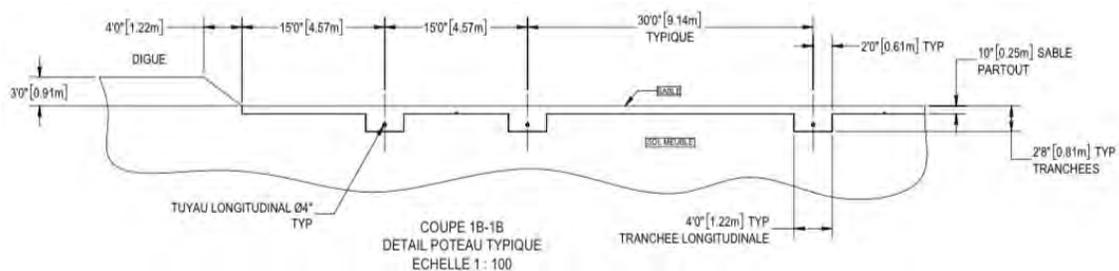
Coupe latérale du design souterrain des substrat et des tranchées de drainage
